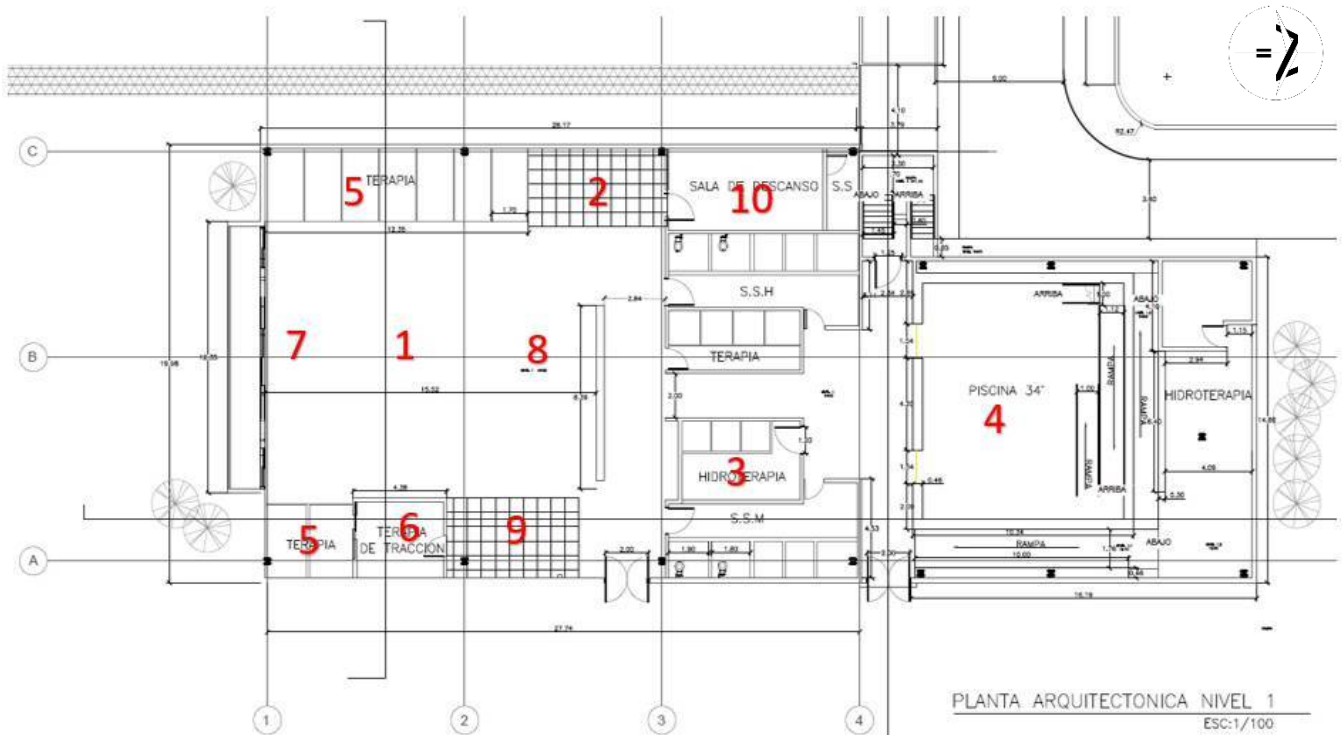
Planta arquitectónica de las terapias que realizan y su distribución actual.
